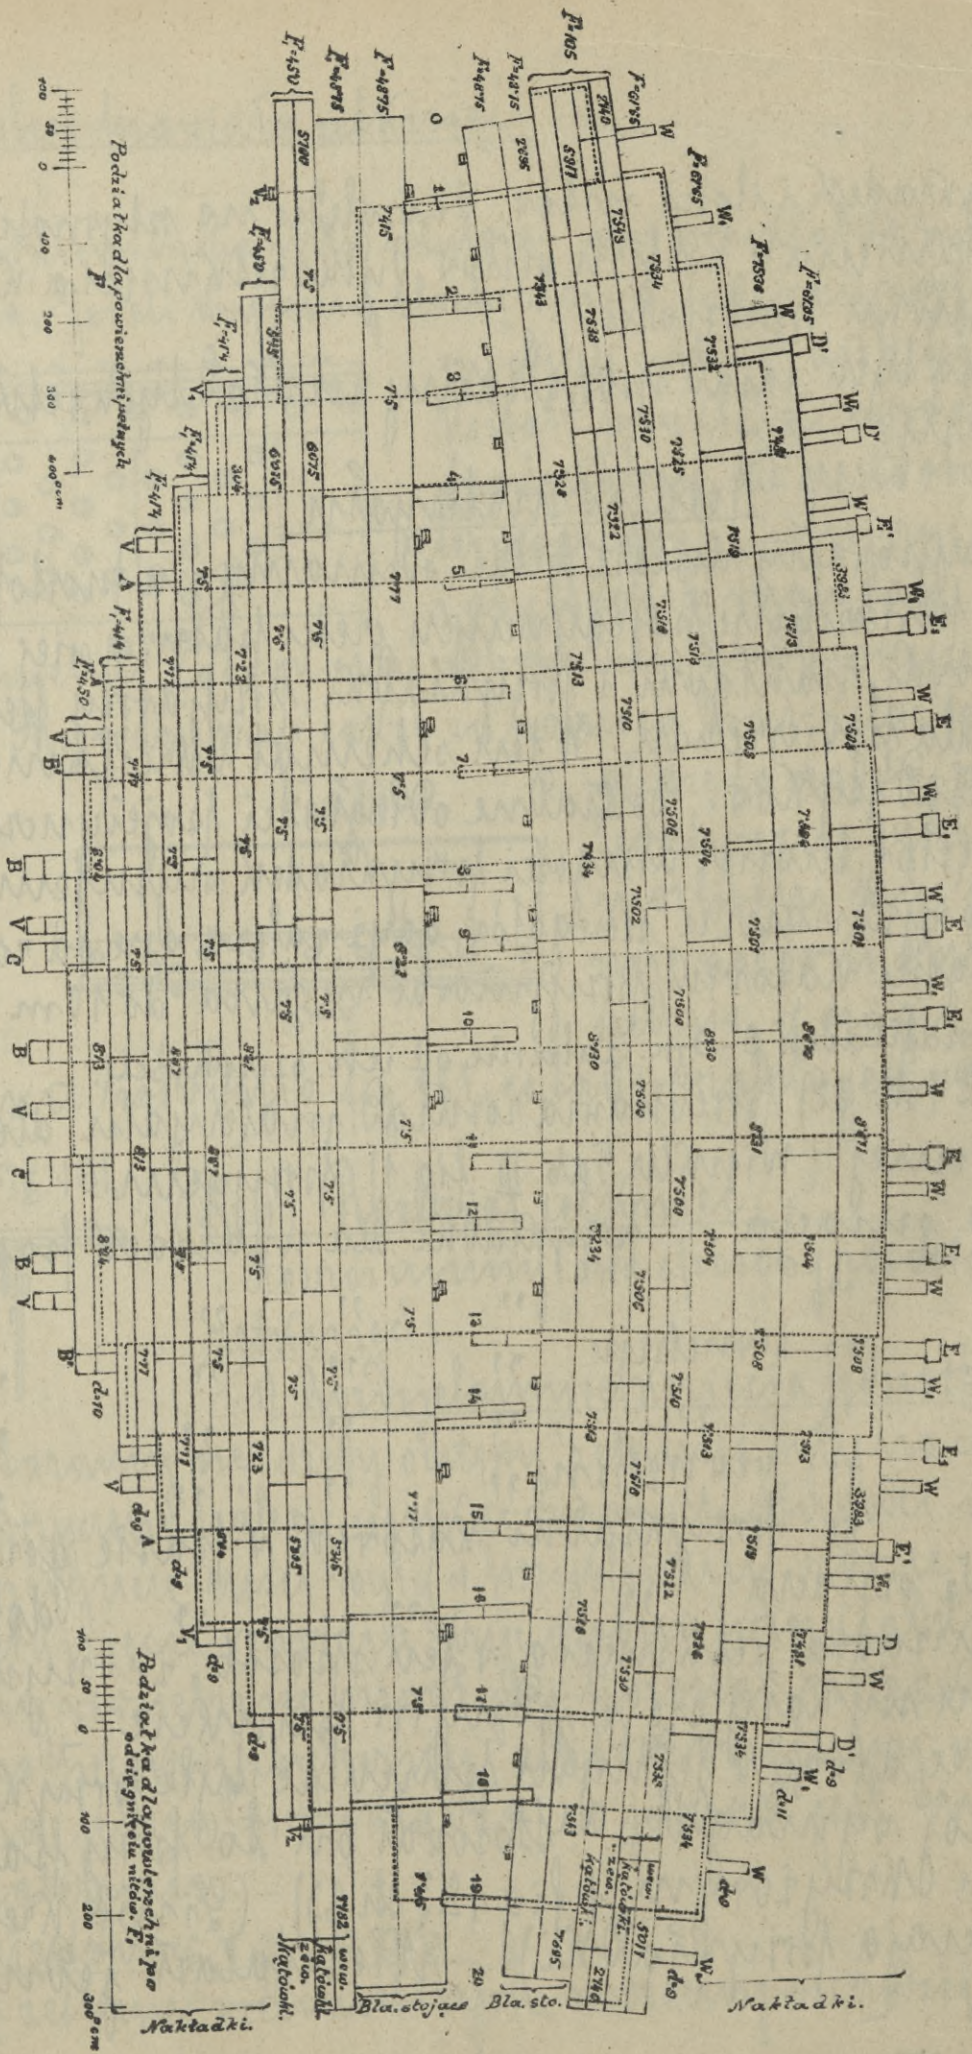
(str. 82) przedstawia rozkład materiału dla belki
